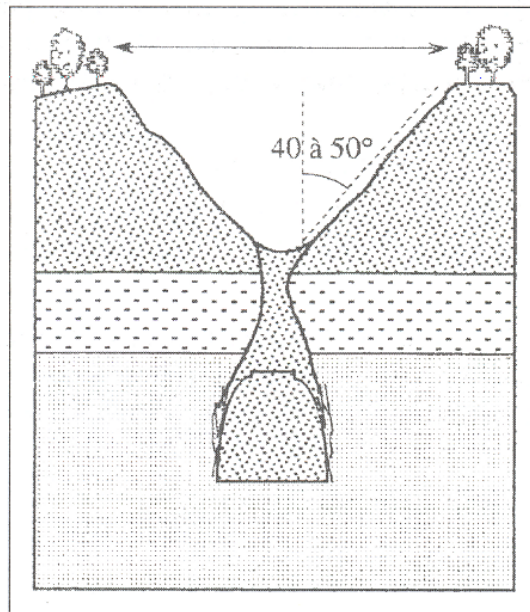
Meccanismo di collasso improvviso con riempimento della cavità (documentazione archivio Pizzarotti).
